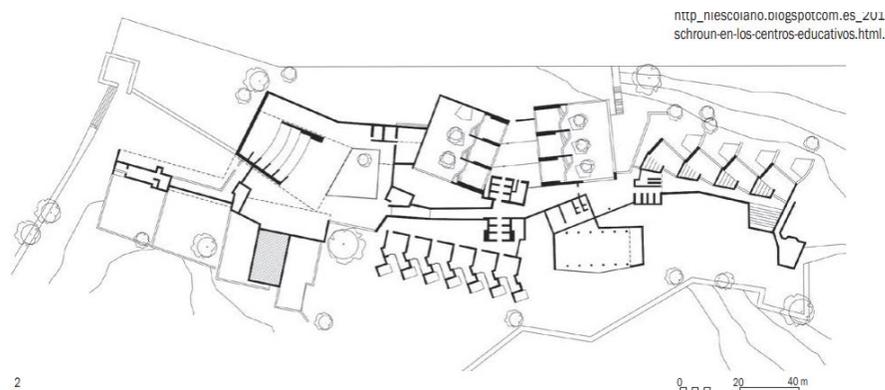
Dibujo planta del centro de enseñanza Darmstadt a partir de la planta de Peter blundell Jones, 1995, “Hans Scharoun”. Londres, Phaidon, p.138. (2017) Carla Sentieri Omarrementeria; Elena Verdejo. Tomado del libro “Las escuelas de Hans Scharoun”
